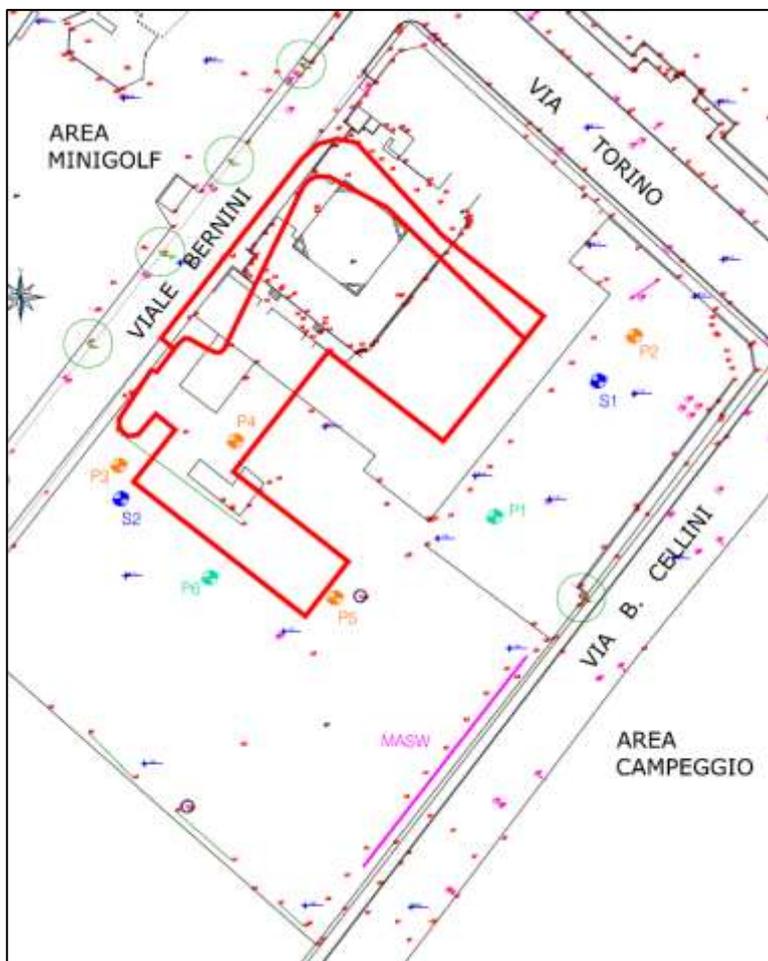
b – ubicazione prove (tav. 2 elab. C2)
